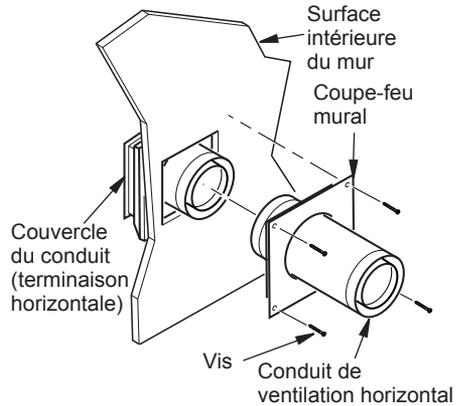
Raccordement du couvercle au conduit de ventilation horizontal
